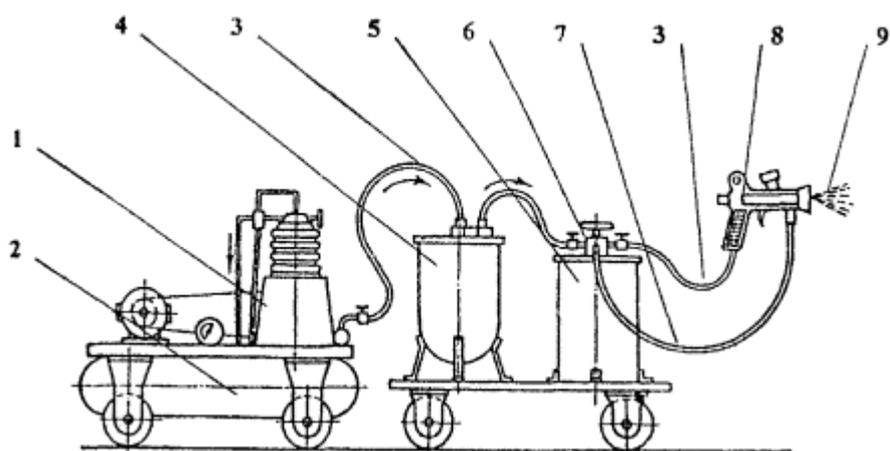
Схема компрессорного огрунтовочного агрегата: 1 - компрессор; 2 - воздухосборник; 3 - воздушный шланг; 4 - масловодоотделитель; 5 - красконагнетательный бачок; 6 - редукционный вентиль; 7 - огрунтовочный шланг; 8 - краскораспылитель; 9 - факел
